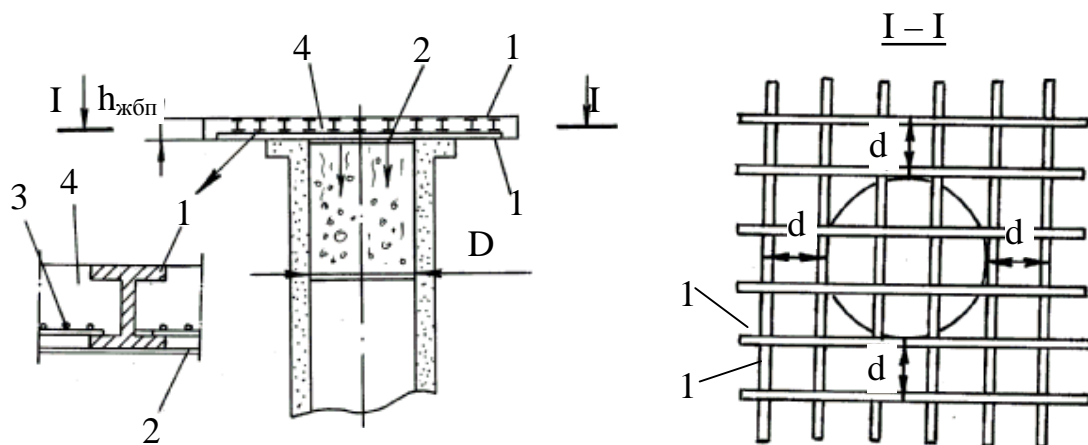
Конструкція плити перекриття устя вертикального ствола ($h_{жбп} \geq 0,1D$): 1 – двотавр; 2 – опалубка; 3 – арматура; 4 – бетон
